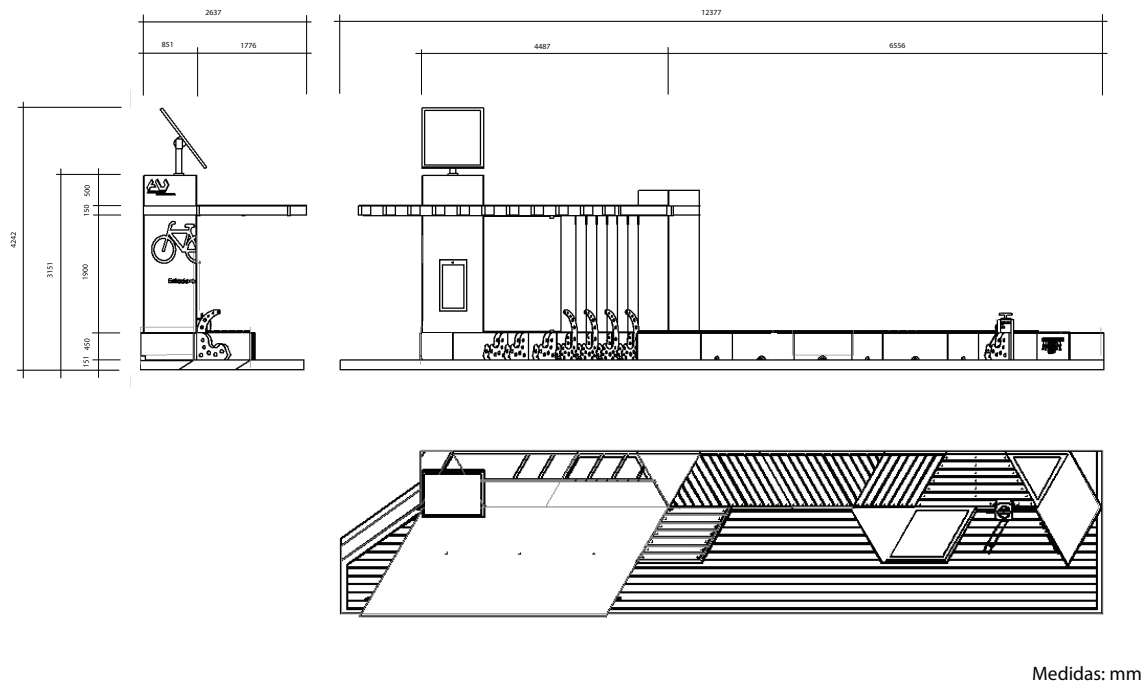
Vista geral da conjugação modular e respetivas dimensões.
